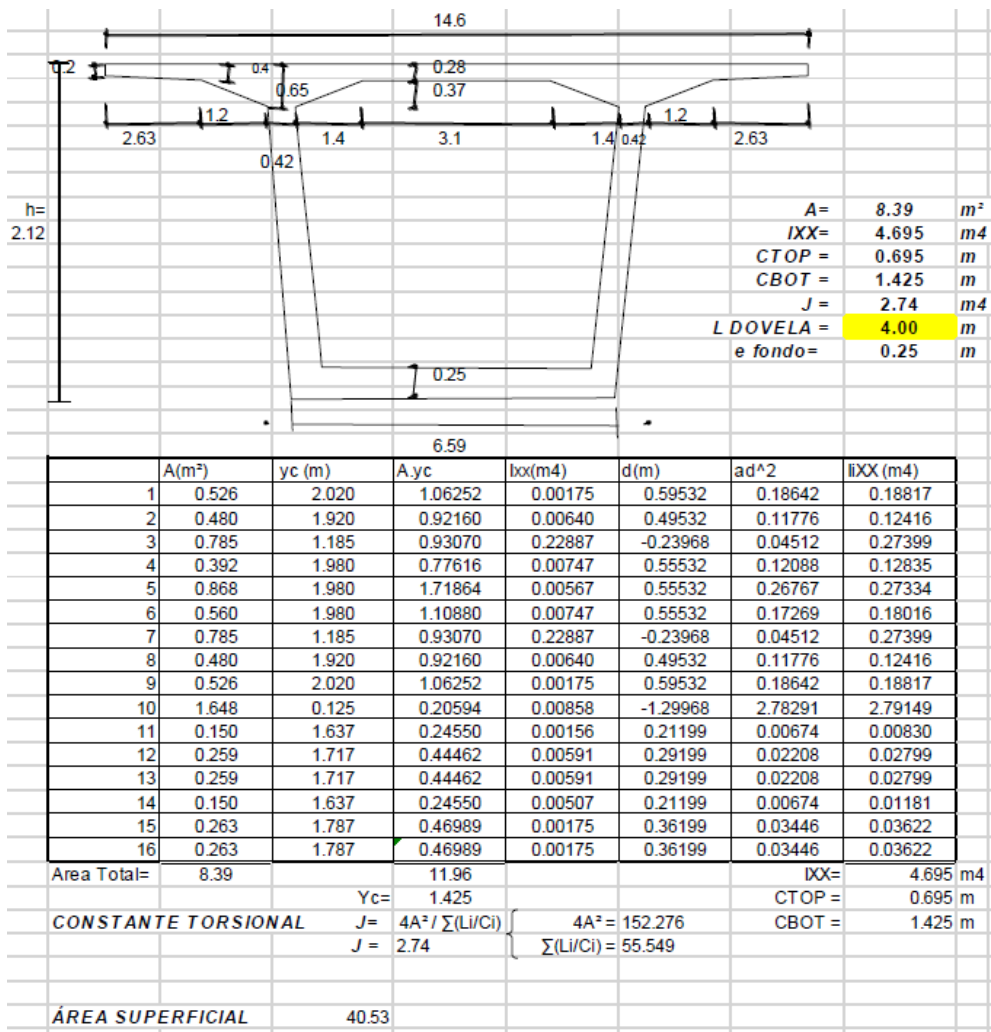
Dimensiones y propiedades de la viga cajón cara menor dovela 8 puente San Pedro.
